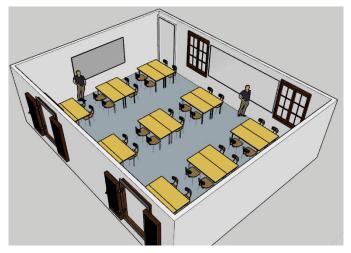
Alternatif B Konsep Layout Ruang Kelas *Collaborative*Sumber: Hapsari, 2018
